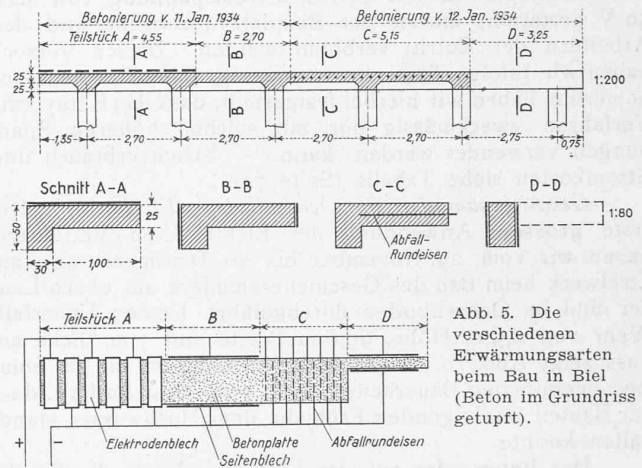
Die verschiedenen Erwärmungsarten beim Bau in Biel (Beton im Grundriss getupft).
